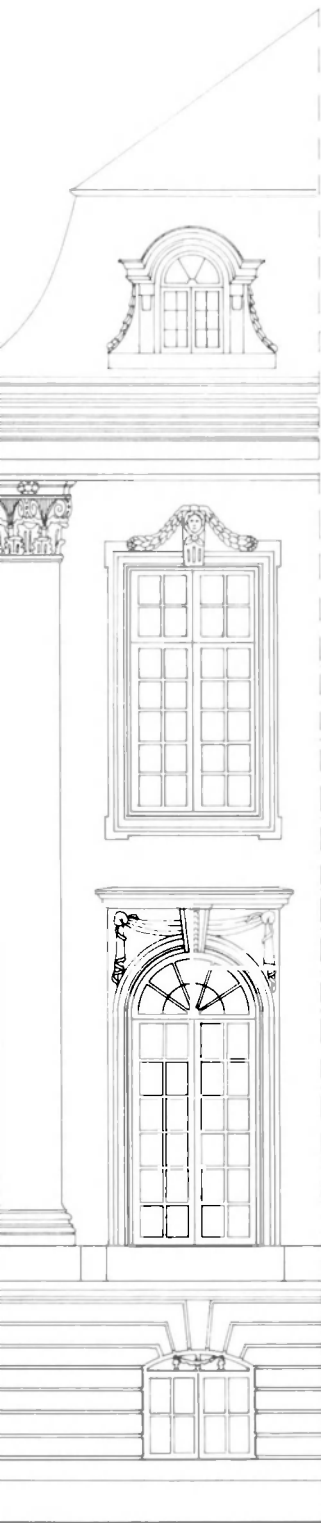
Élévation d'une travée d'angle de la façade (Dessin de Gérard Michel, 1982).
